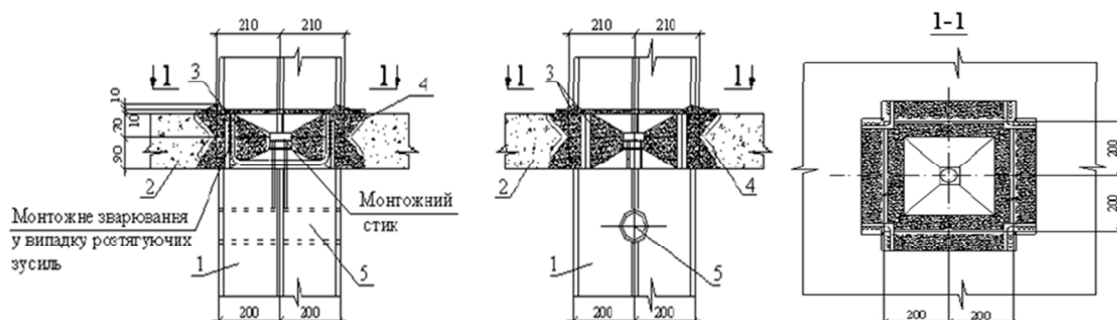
Схема шпонкового з'єднання надколонної плити з колоною: 1 – колона; 2 – плита; 3 – бетон (шпонка); 4 – сталеві обойми; 5 – монтажні отвори для монтажу плит
